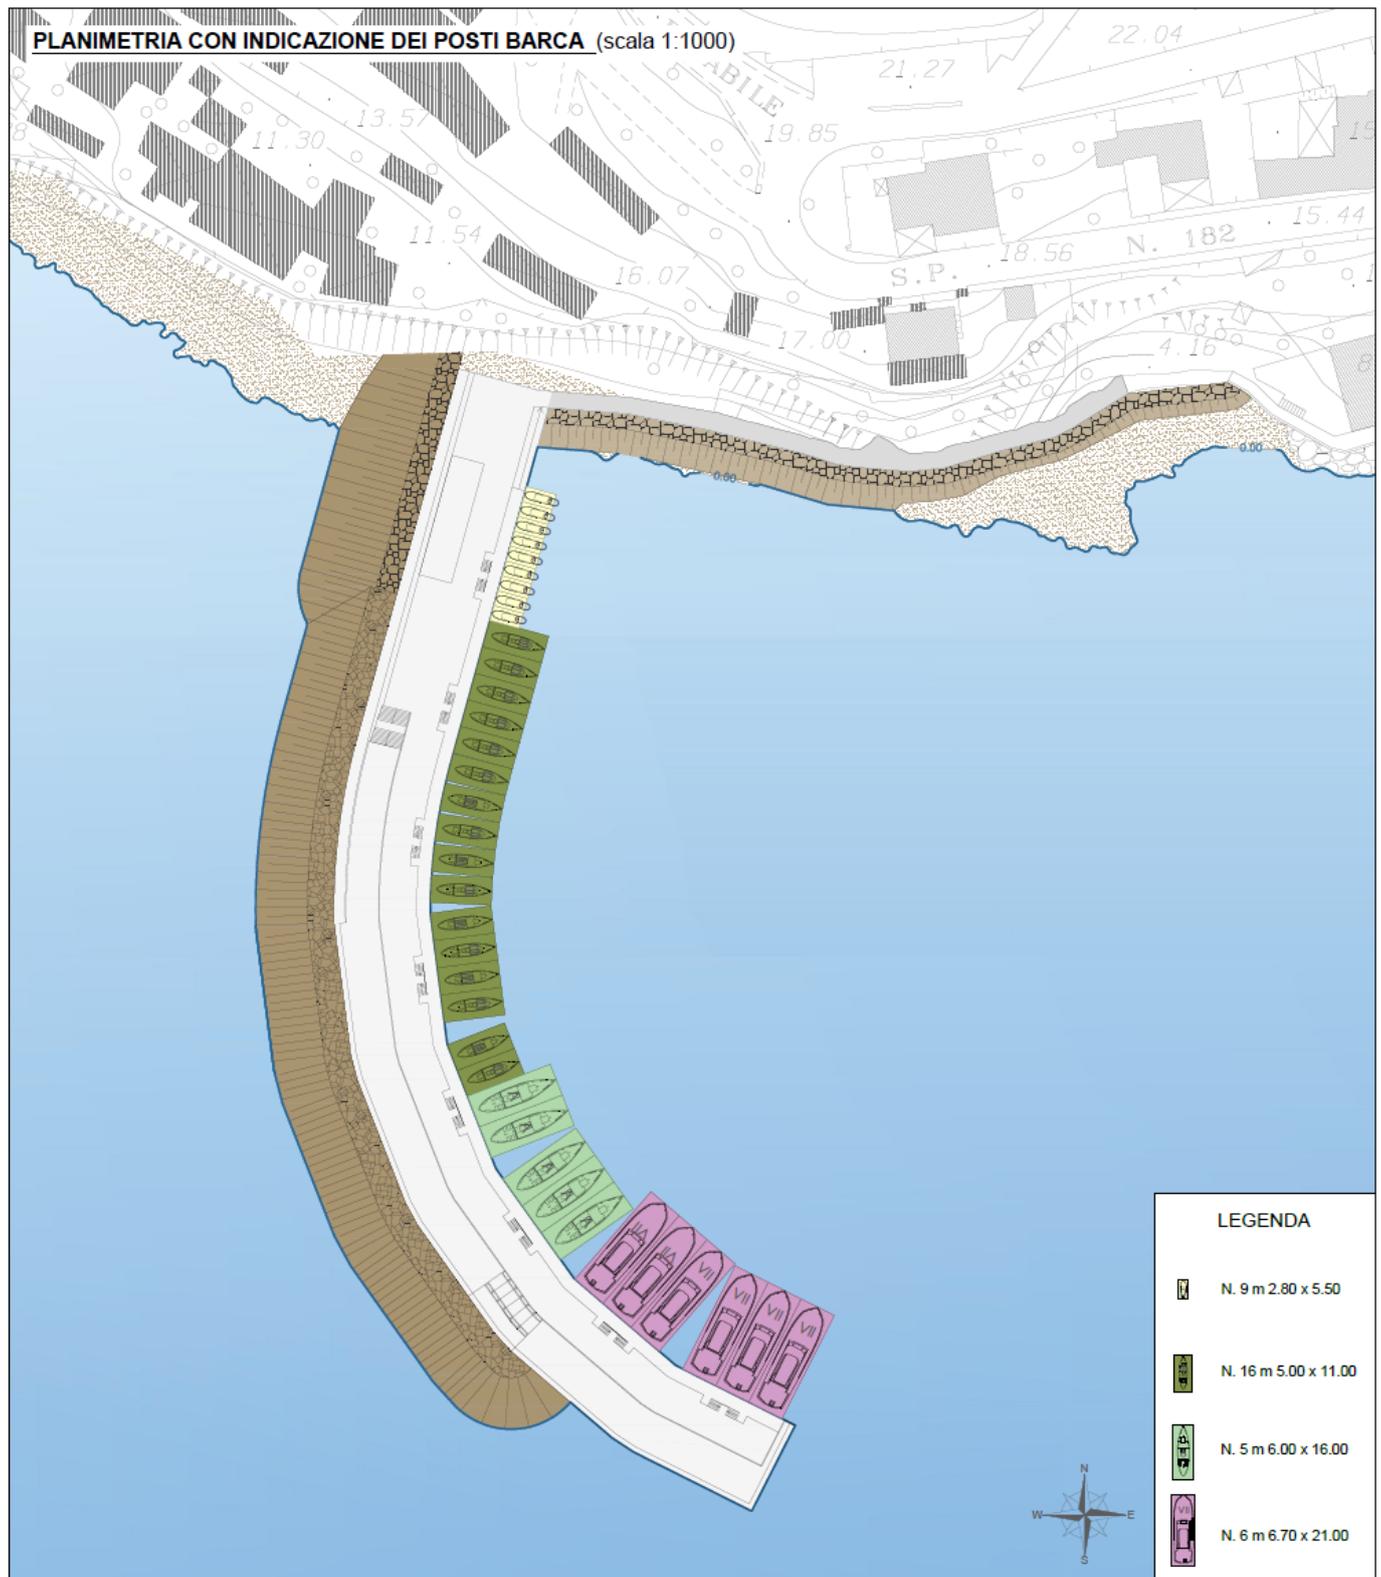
Piano barche proposto nel presente progetto definitivo I Stralcio
